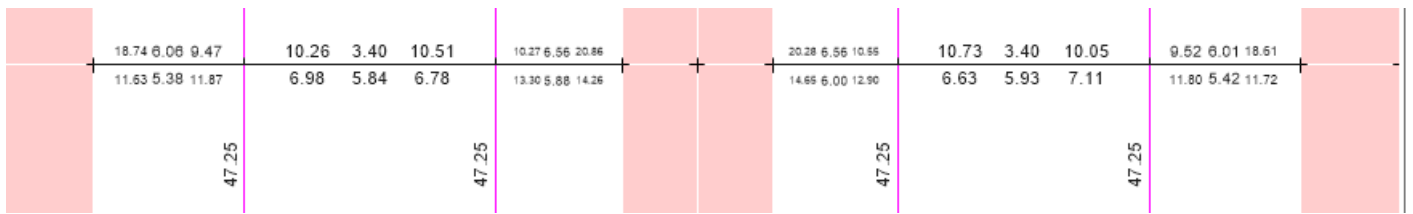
Acero Requerido por momentos en Vigas 4° Piso
